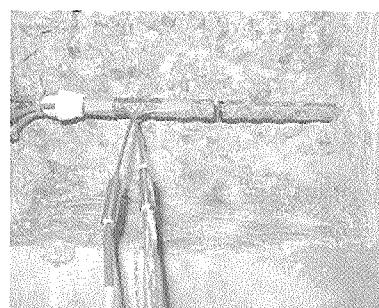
鉄筋ゲージ取付け, 鉄筋切断
